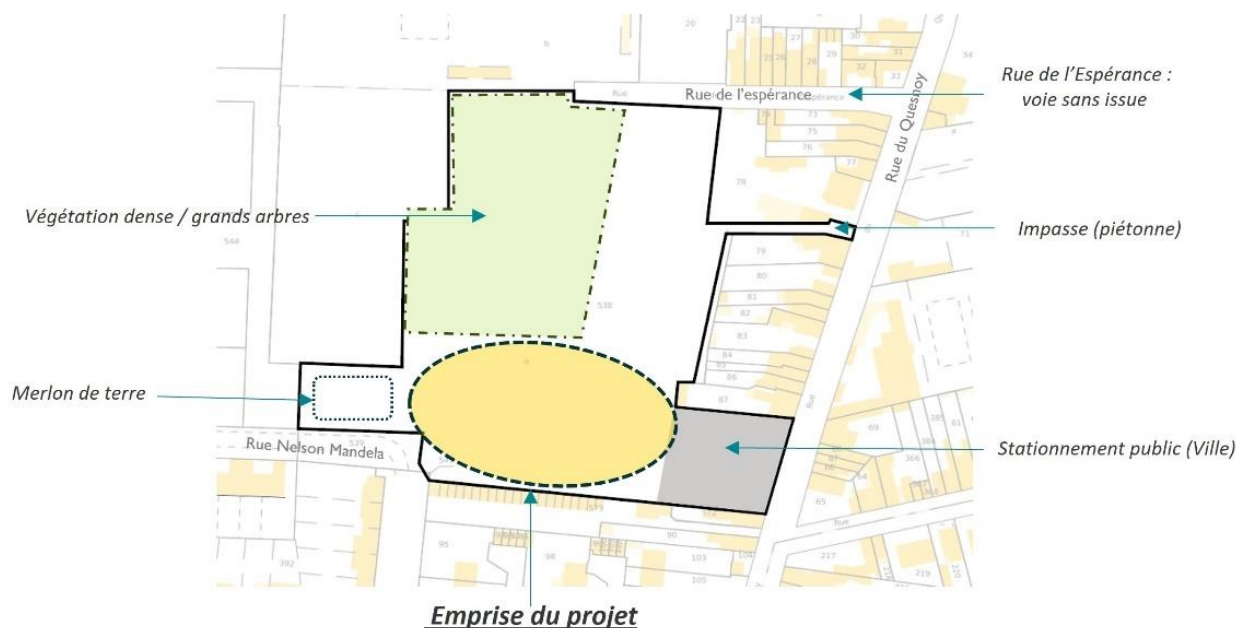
SITE D'IMPLANTATION DU PROJET
